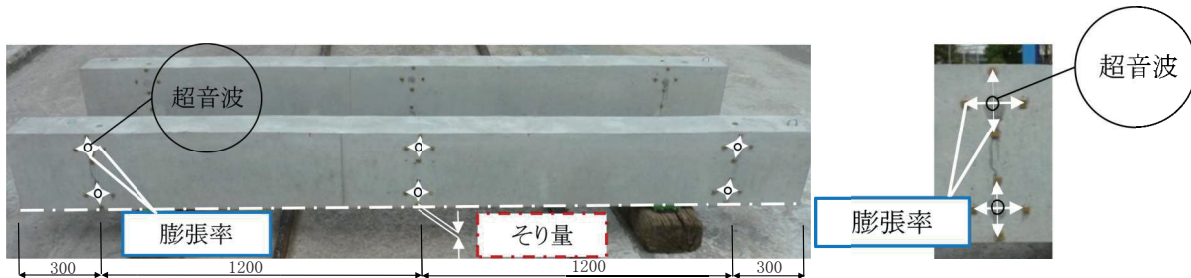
屋外曝露試験体の測定位置 (単位: mm)
